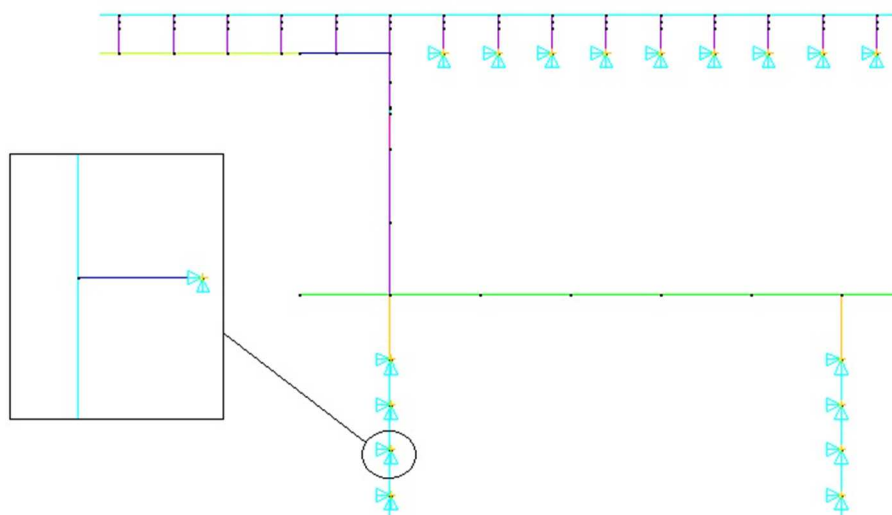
Pormenor da modelação da interação estaca-solo de fundação.
